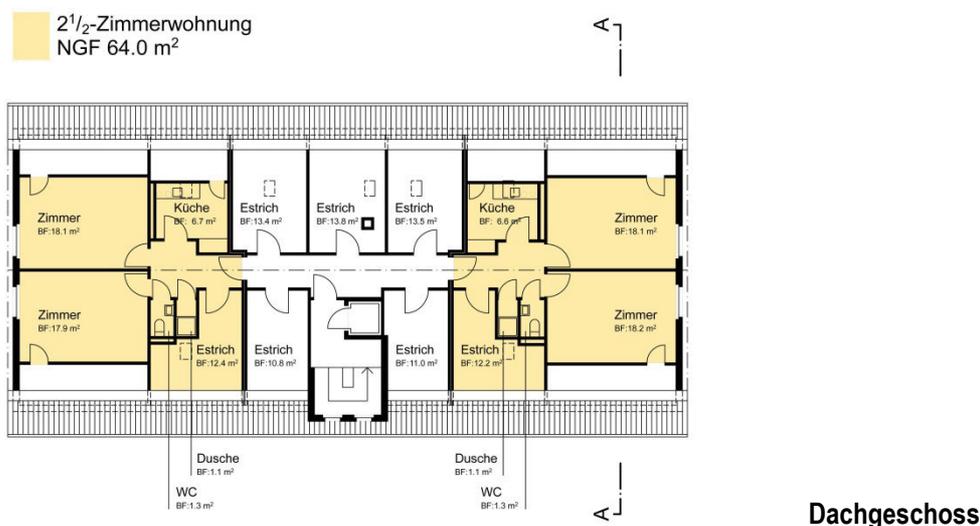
Fallbeispiel, Plan Dachgeschoss
